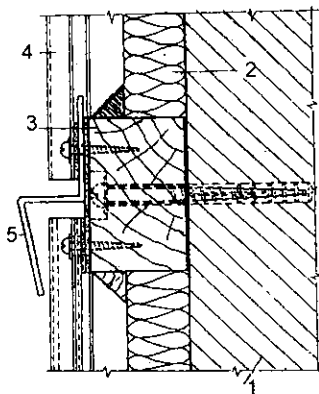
Конструкция дополнительного утепления с наружной листовой облицовкой
